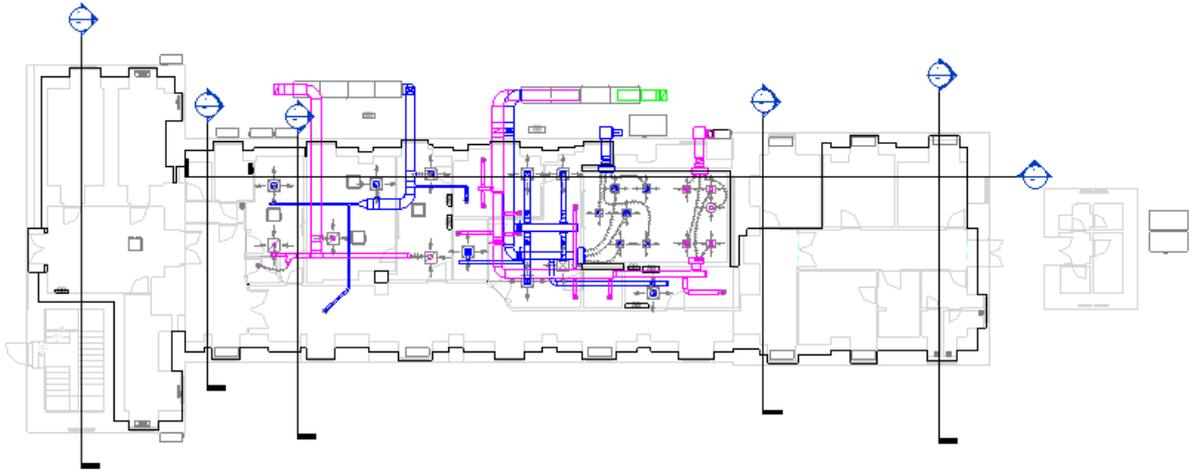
Pianta dei pavimenti: piano inferiore Revit
